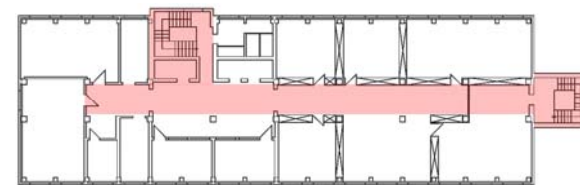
Regelgeschoss - Grundriss 2.0G
